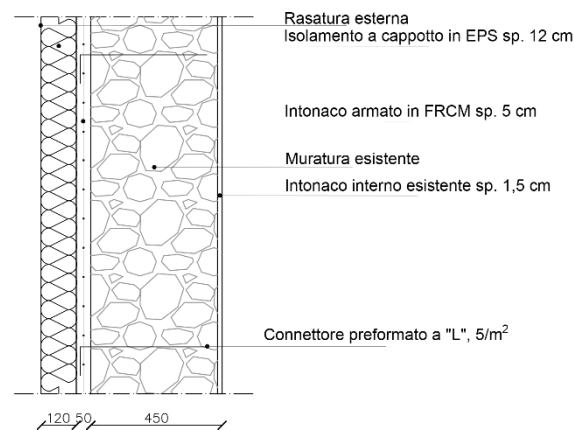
Dettaglio in sezione del consolidamento strutturale e dell'intervento di retrofit energetico della muratura mediante intonaco armato e connettori trasversali sul solo lato esterno.
